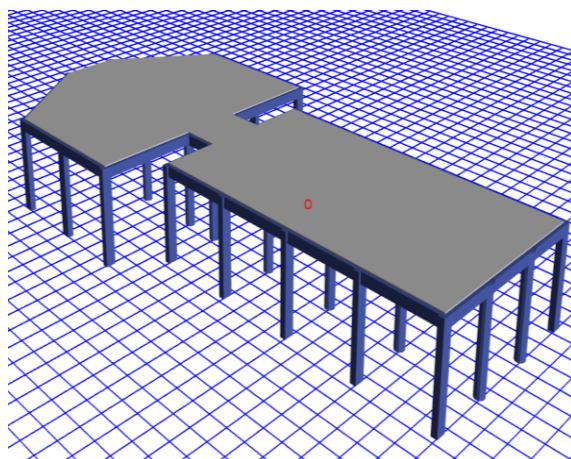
Modelo en ETABS de la sección 1 de la estructura.
